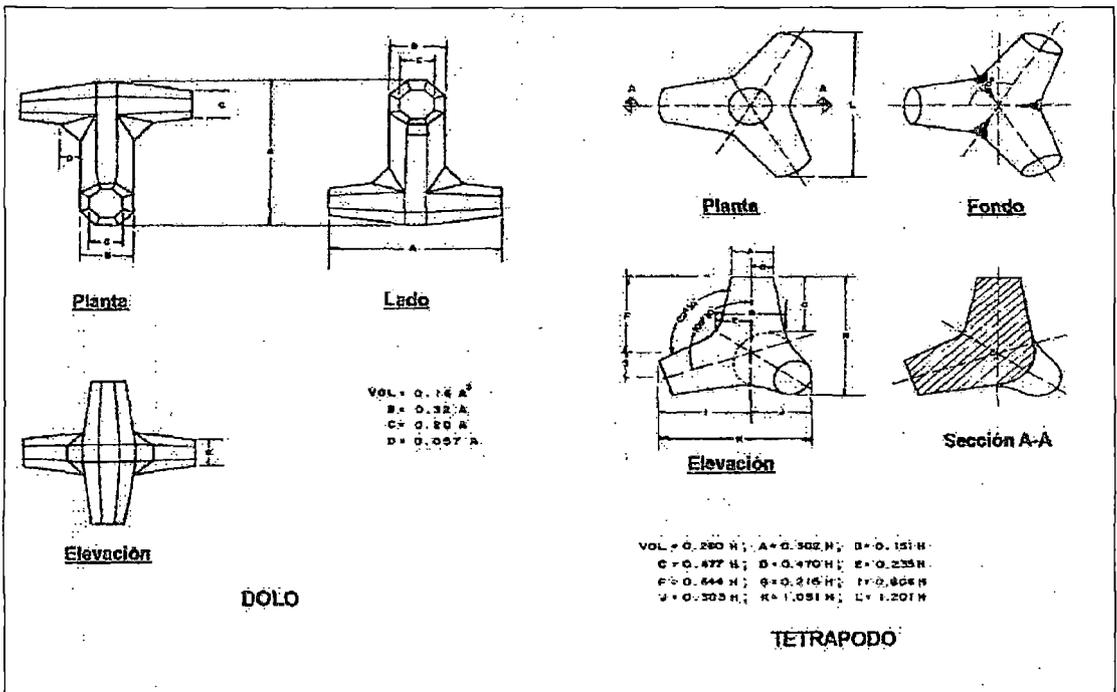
Elementos prefabricados de Concreto.(Fuente: Ingeniería de Costas: Armando Frías – Gonzalo Moreno).
